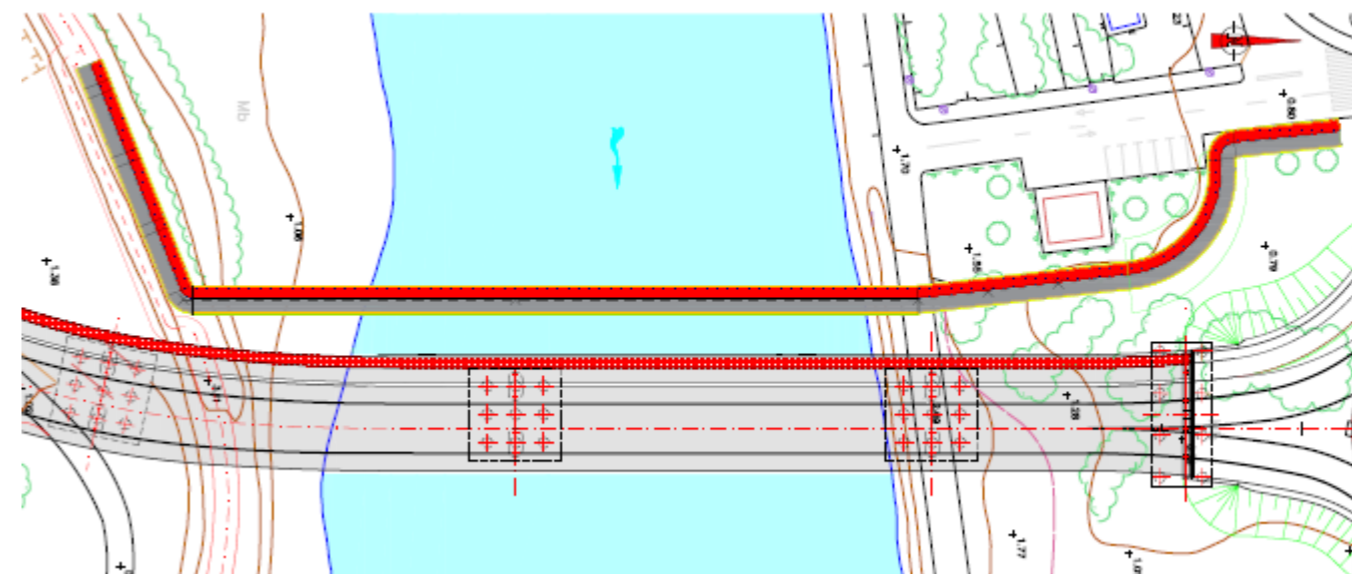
Plano en planta con la ubicación de la pasarela peatonal. Para más detalle, véase los Planos.
